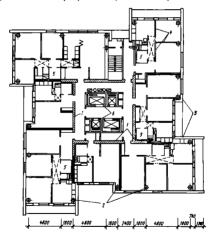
Каркасно-панельный 25-этажный жилой дом с монолитным идром жесткости. План типового этажя:
